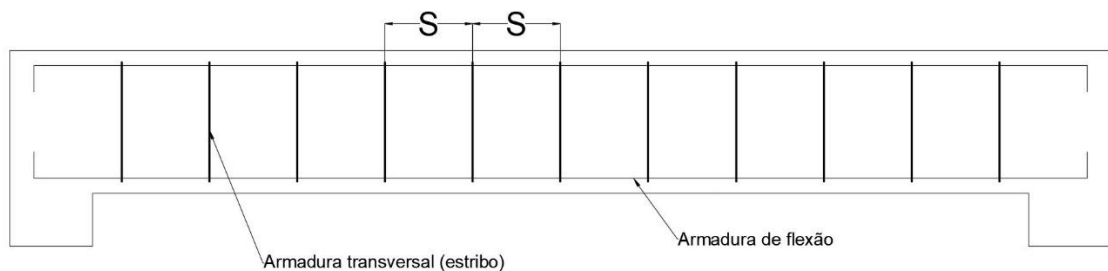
Espaçamento longitudinal entre estribos (Elaborado pela autora, 2018)
